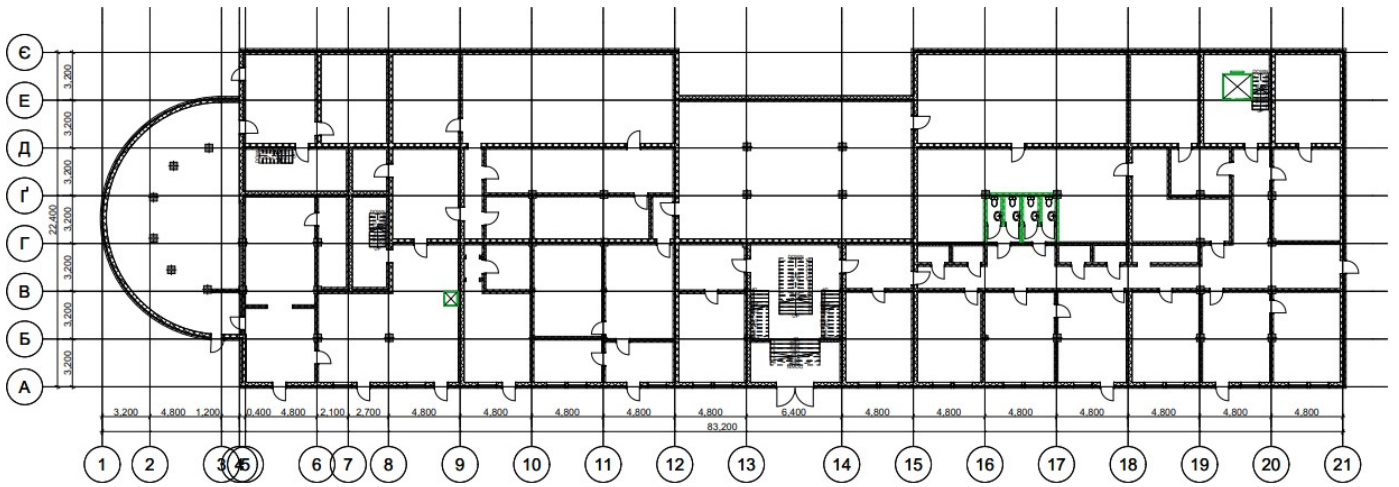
План 4 поверху з демонтажем стінових конструкцій
